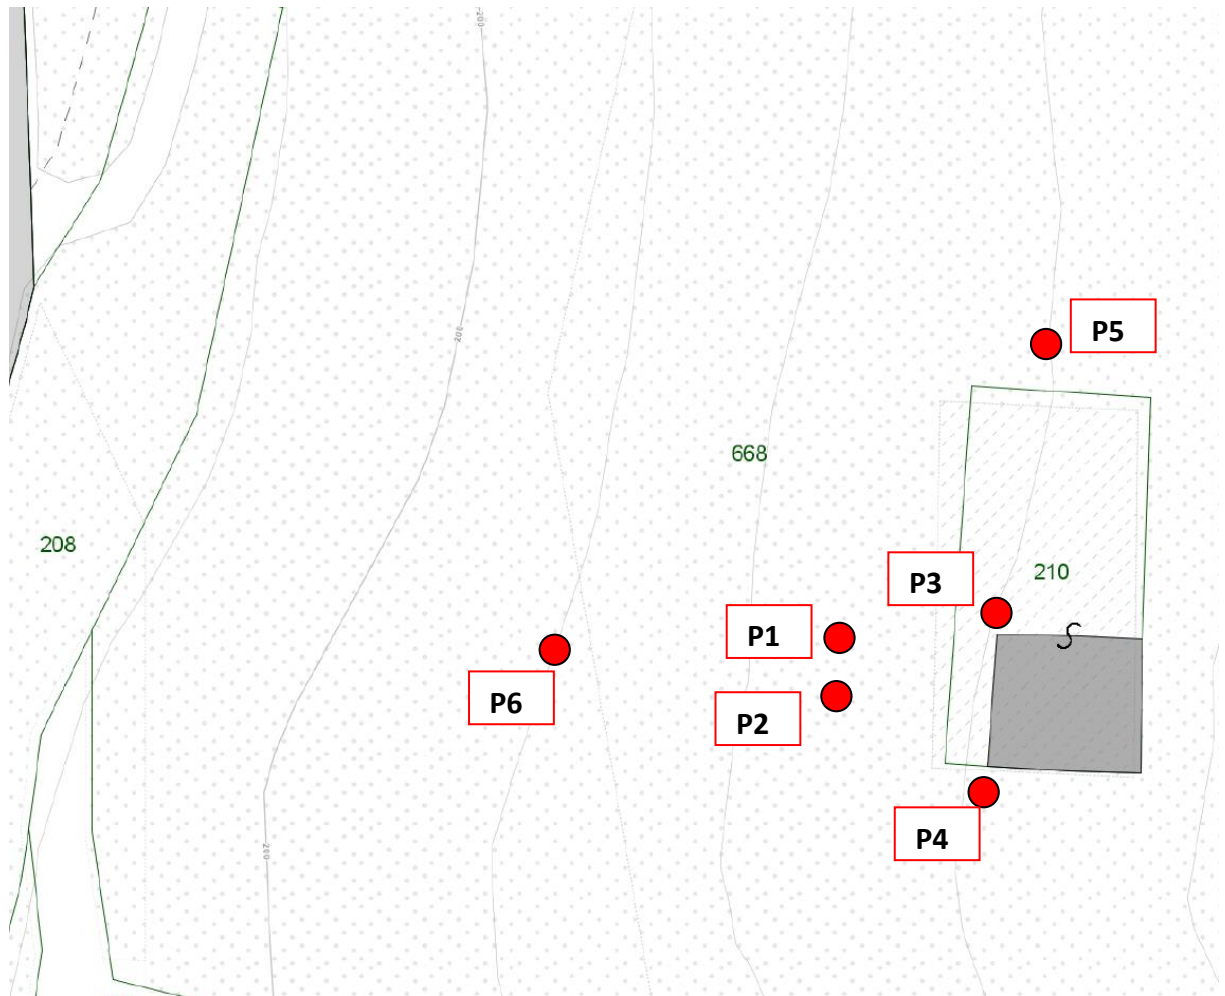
Estratto planimetria intervento ed ubicazione indagini
